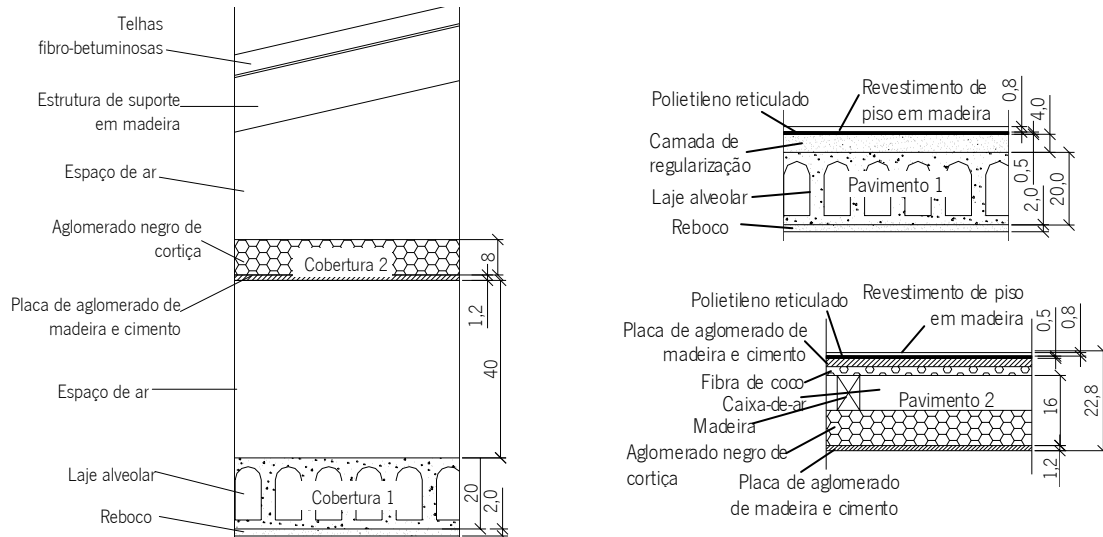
Corte esquemático das soluções construtivas não convencionais das coberturas e dos pavimentos
